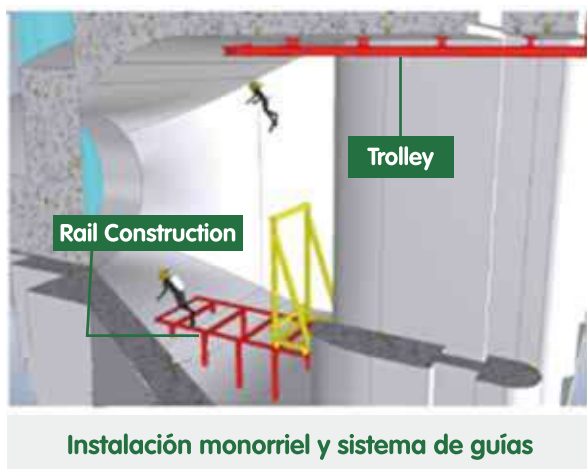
Instalación subacuática mamparo mecánico. Recuperado de: (DCN Diving BV, 2021)
